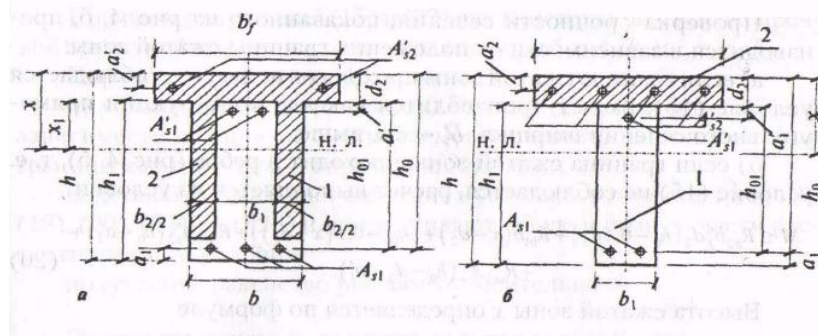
Поперечний перетин балки, що підсилюється нарощуванням бетону стислої зони
